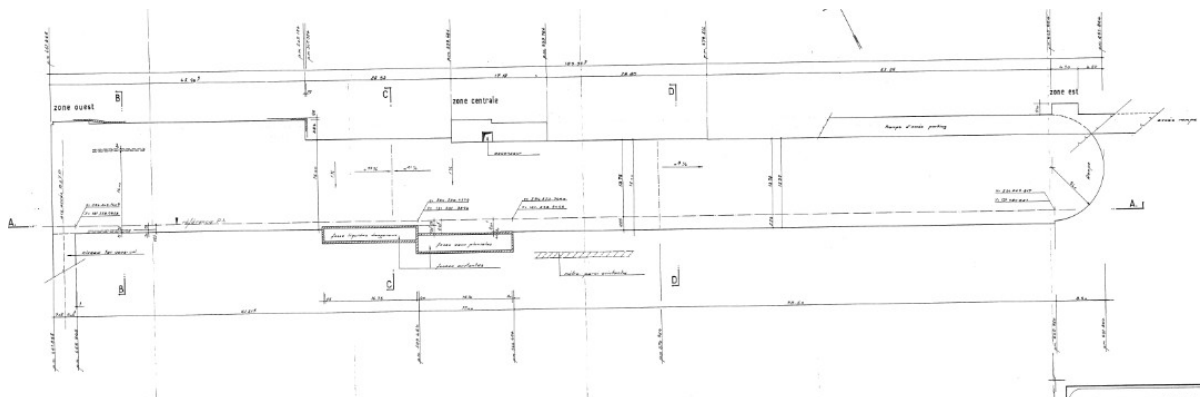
Plan de principe des collecteur liquides dangereux et eaux pluviales_plan 171232
